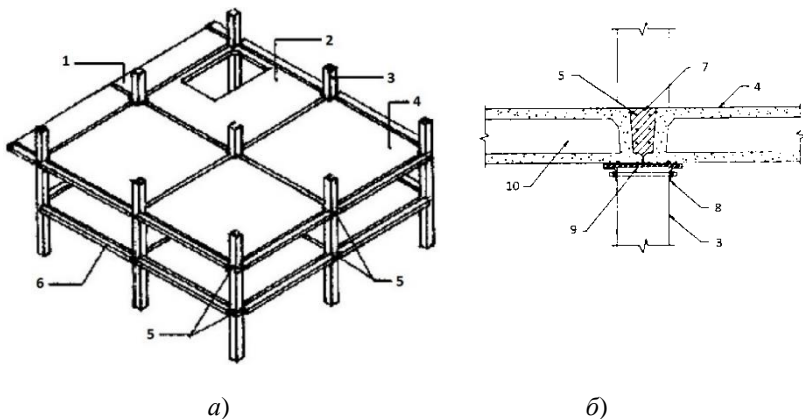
Конструктивна система IMS [9]: а) – загальний вигляд; б) – прихований ригель в стику плит; 1 – консольна плита; 2 – плита з отвором для сходів; 3 – колона; 4 – типова плита; 5 – попередньо напружена арматура; 6 – фасадна розпірка; 7 – монолітний бетон; 8 – сталеві кутики; 9 – тимчасова опорна рамка; 10 – канал
